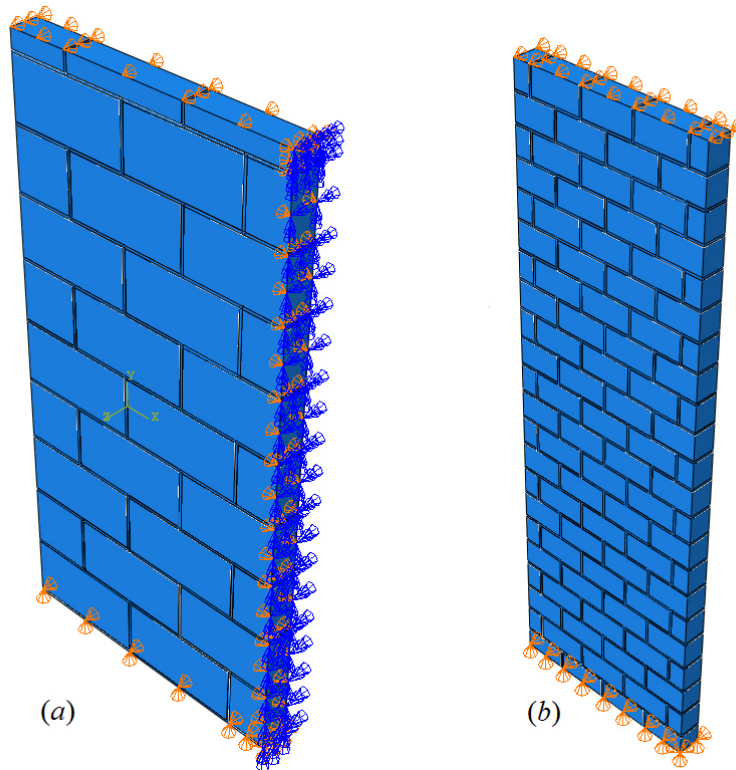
Condiciones de frontera en. (a) Muro de concreto ligero y (b) Muro de concreto normal.
